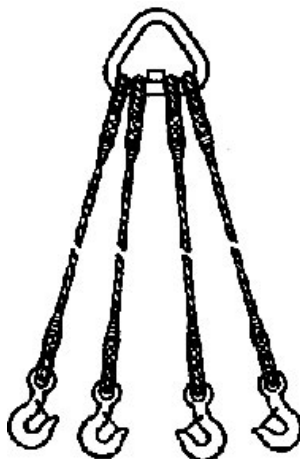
Строповочное приспособление типа 4СК1
